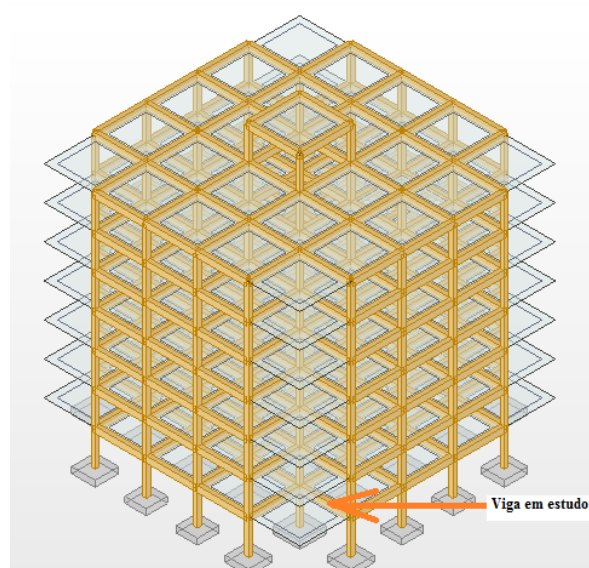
b) Vista geral da estrutura em estudo e localização dos elementos estruturais em análise de esforços.
